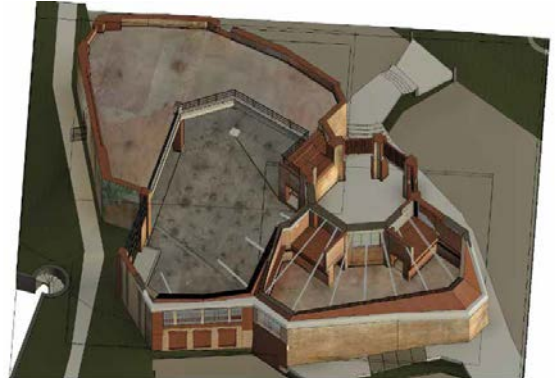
| Vista 3D de los muros exteriores de los bloques 10 y 11 con inserción de los fotoplanos correspondientes y sección horizontal 3D con inserción de los fotoplanos de pavimentos y muros interiores. | Vista 3D delle pareti esterno dei blocchi 10 e 11 con inserimento dei relativi fotopiani e sezione orizzontale 3D con inserimento dei fotopiani relativi a pavimenti a pareti interne.
